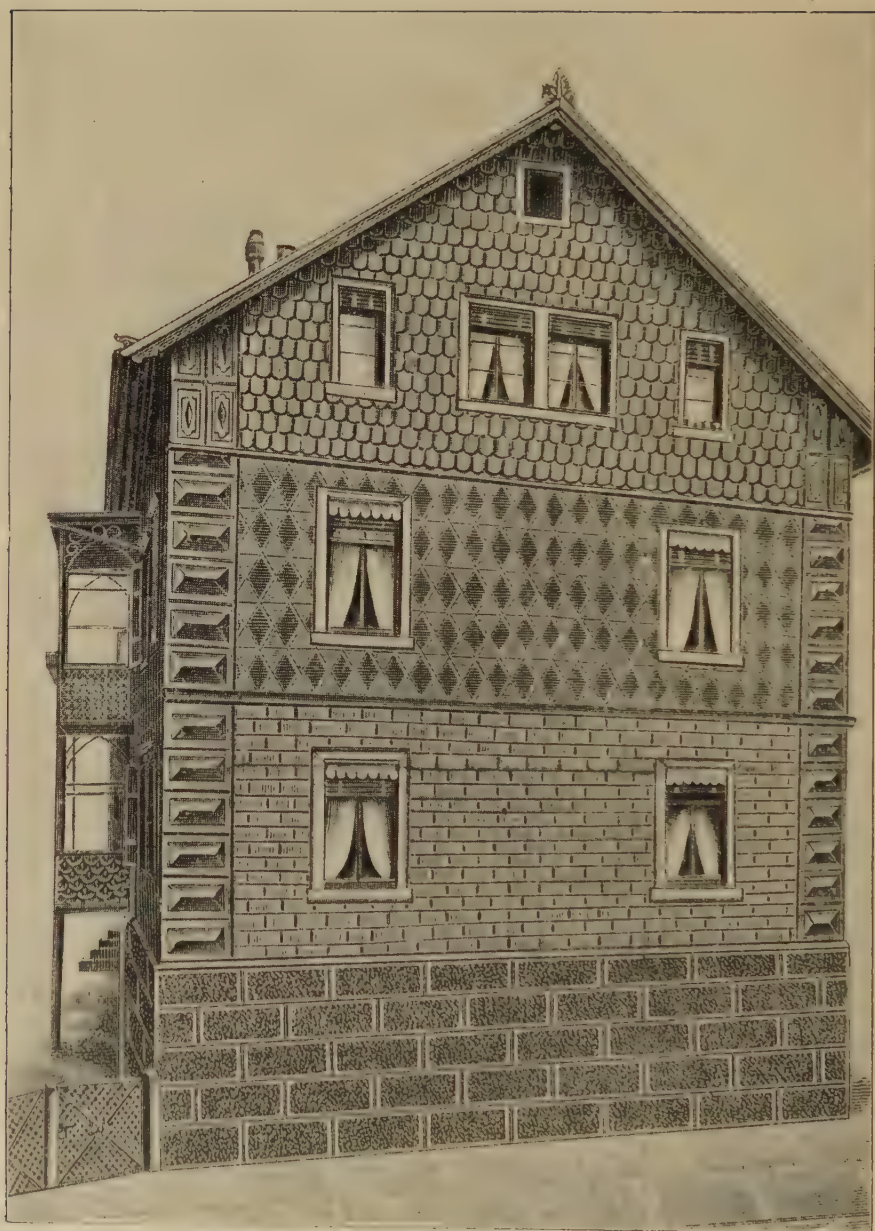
Mit Blech verkleidete Hausfassade (1900)
